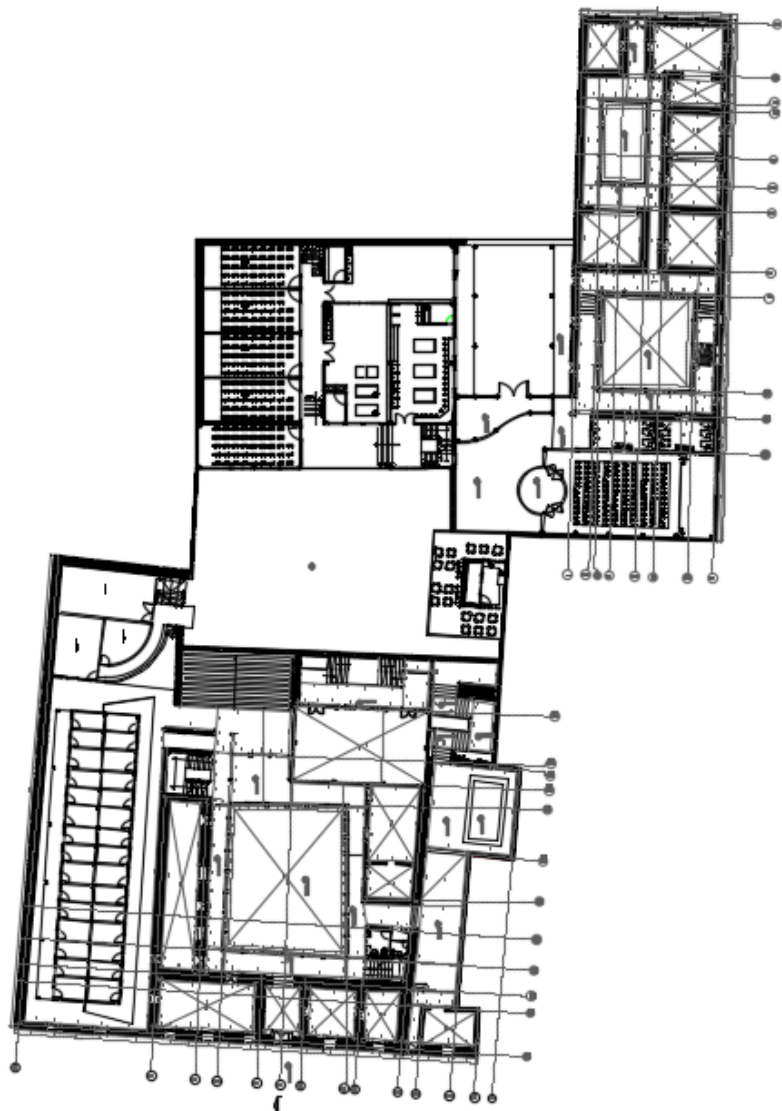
, vista plano arquitectónico de la Casona (1 planta), Fuente: Autor propio, 2016.
